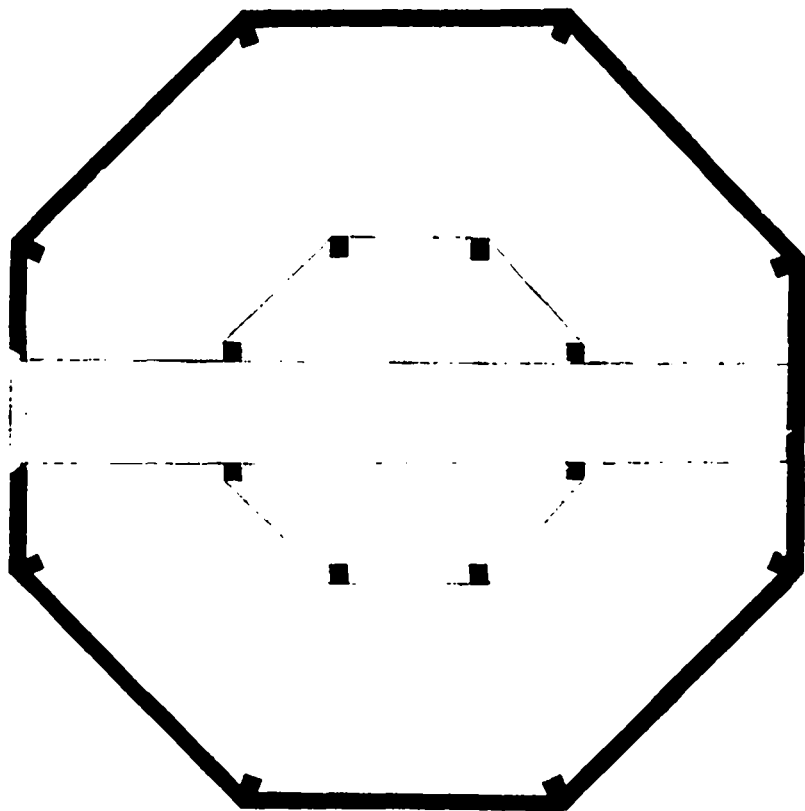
FIG. IV.—VUE EN PLAN, A LA HAUTEUR DES COMBLES.
